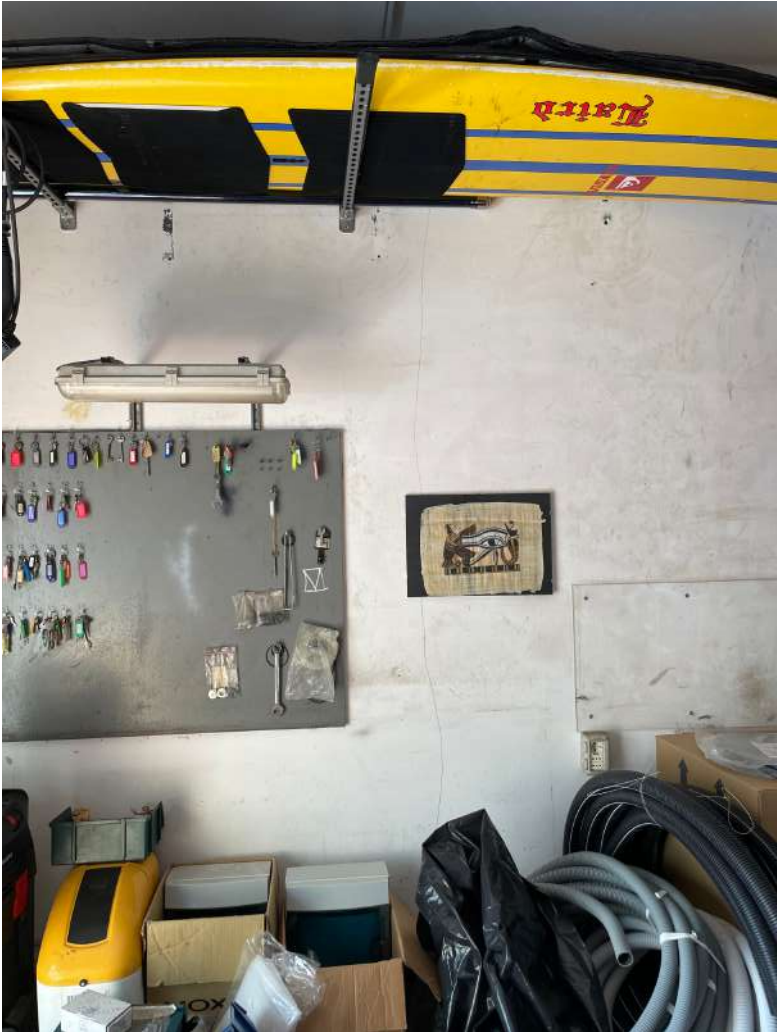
dettaglio tramezza separazione con civ. 4R
